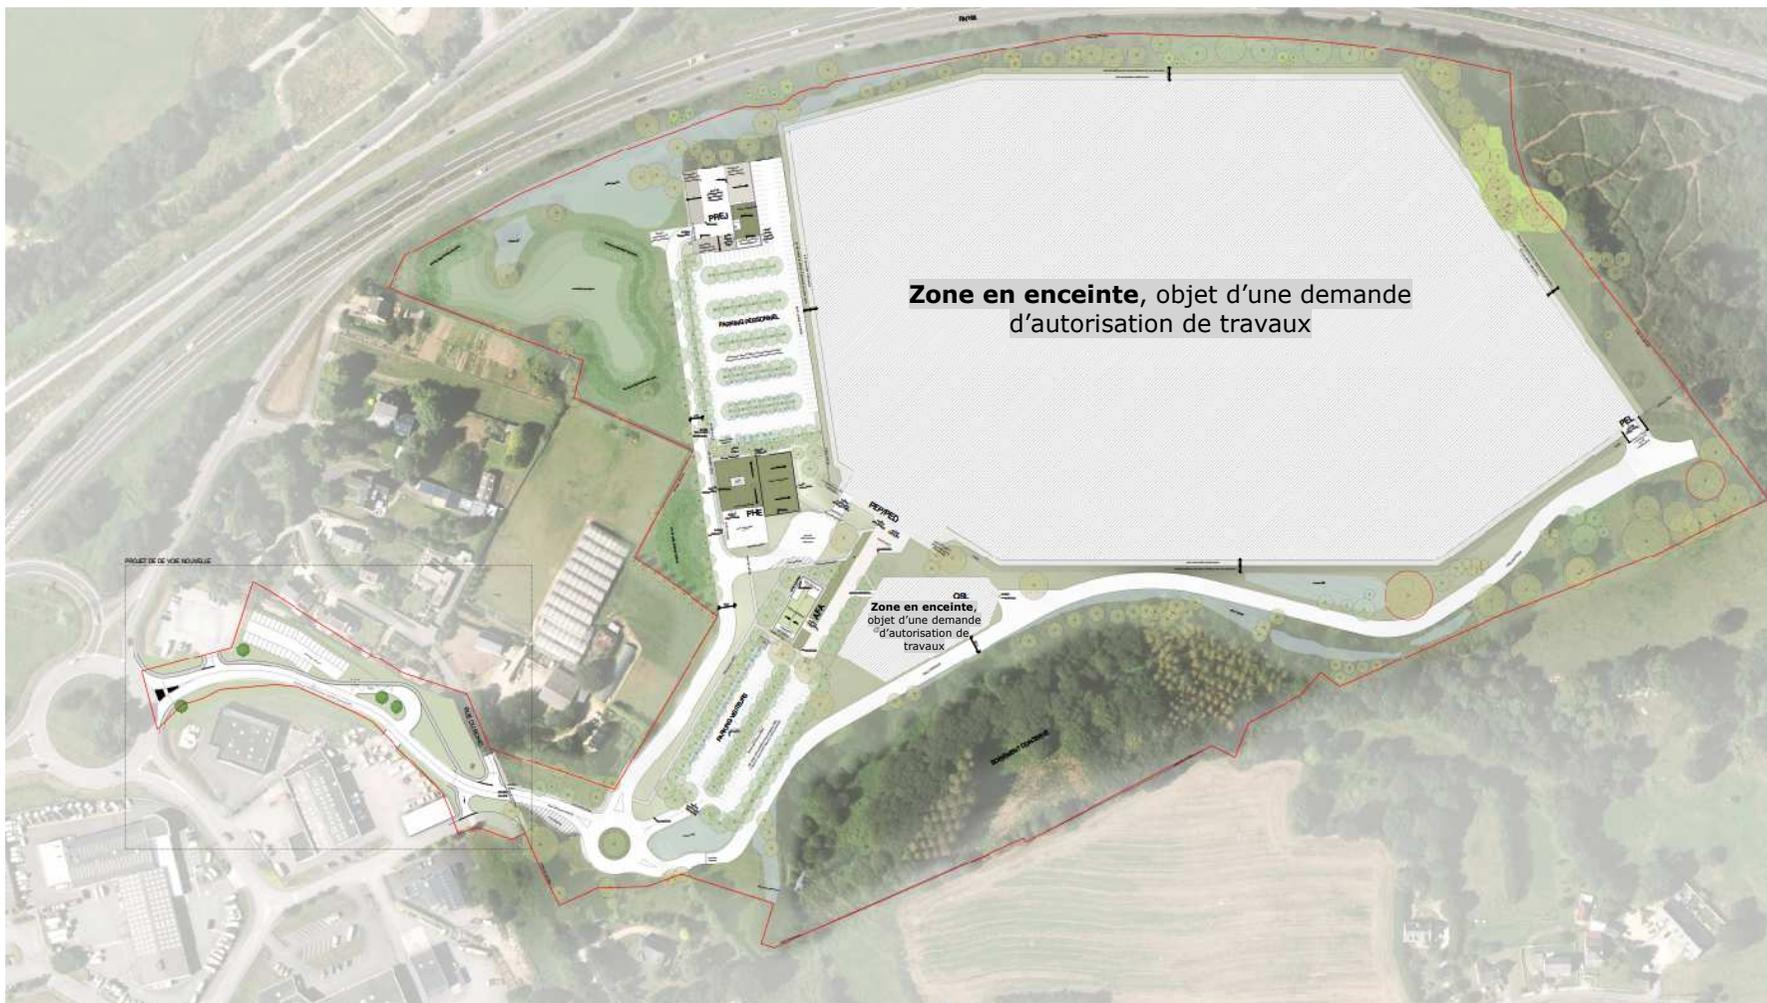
Plan masse du projet global (le plan masse au 1/600° est consultable en annexe, Pièce K) (Source : GROUPE 6 Architectes)
